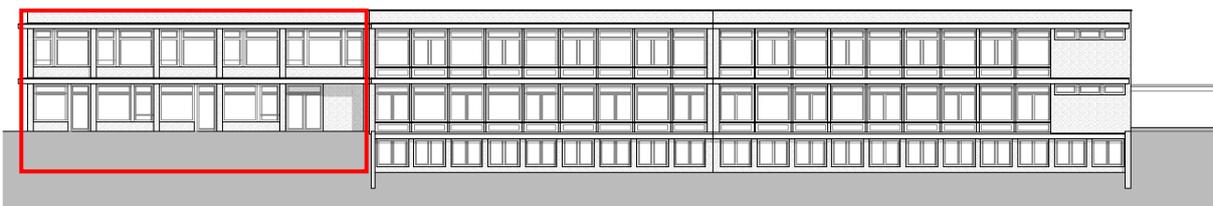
Südwestfassade Spezialtrakt mit geplanter Erweiterung
